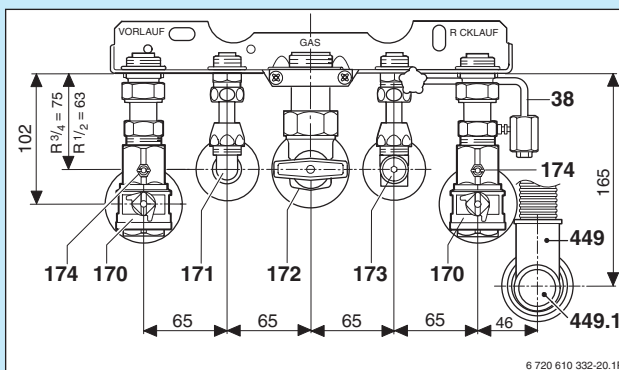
Montageanschlussplatte mit Unterputz-Installation (fertig montiert)
